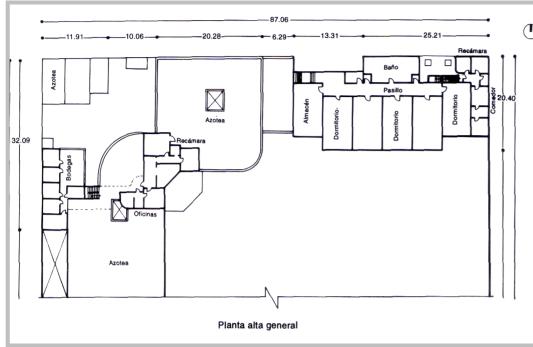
Planta general del proyecto "Casa para ancianos Arturo Mundet"
